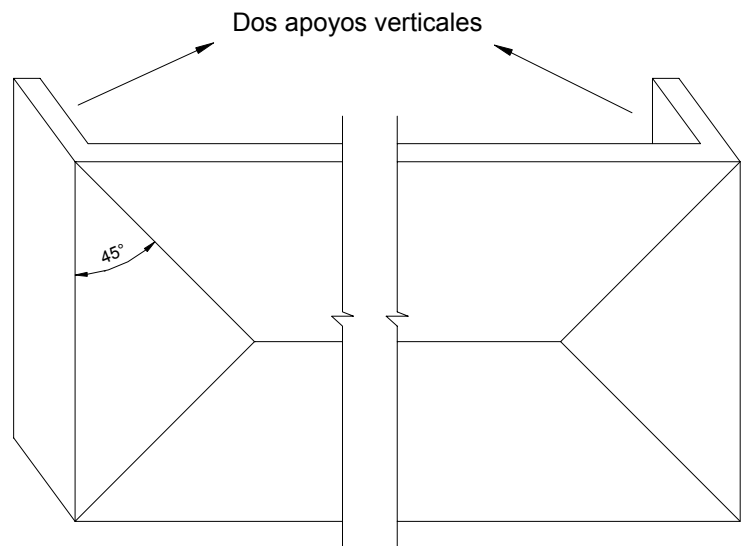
Esquema de colapso simplificado para un muro con dos apoyos verticales.
